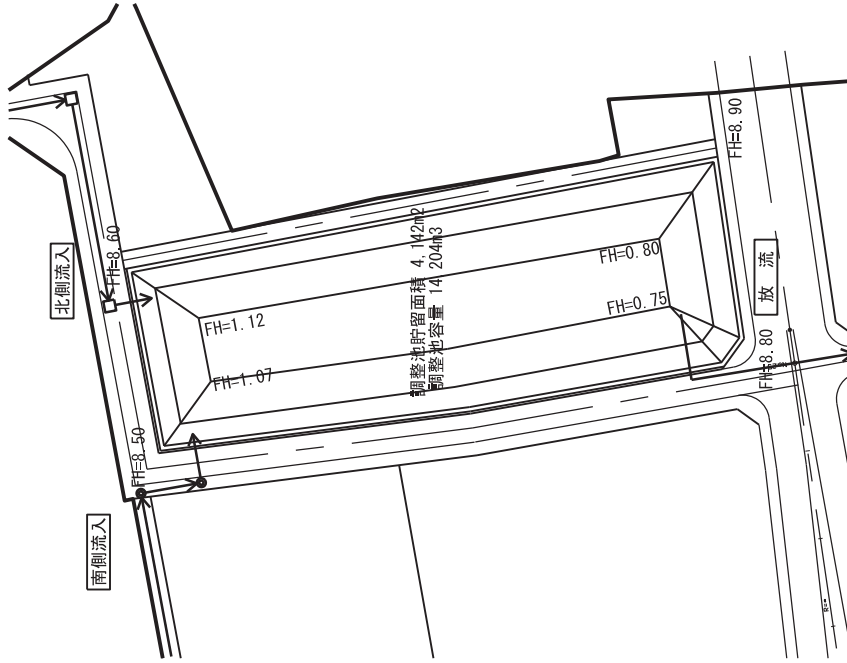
(1) 調整池計画平面・断面図 (第1調整池)
